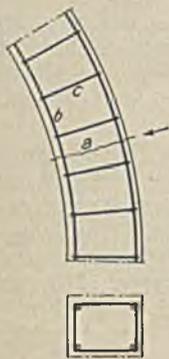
Druckwirkung auf einen starken Eisenbetonausbau.
